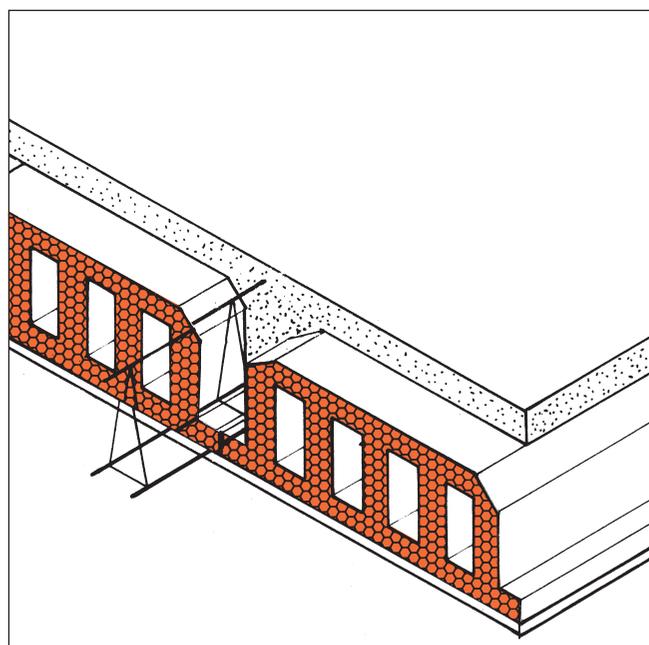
Isolamento e alleggerimento di solai con manufatti stampati in EPS.
